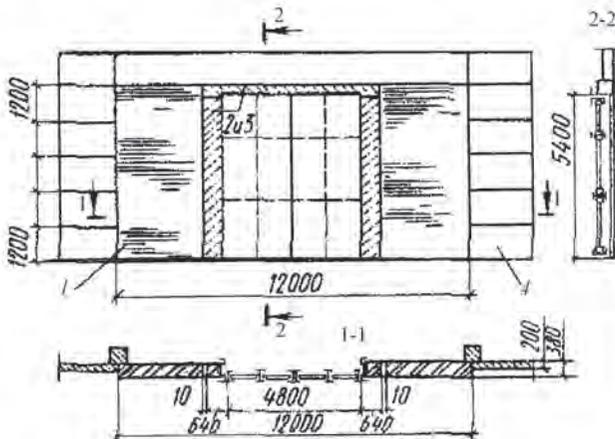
Оформление проема ворот в производственных зданиях с панельными стенами:
